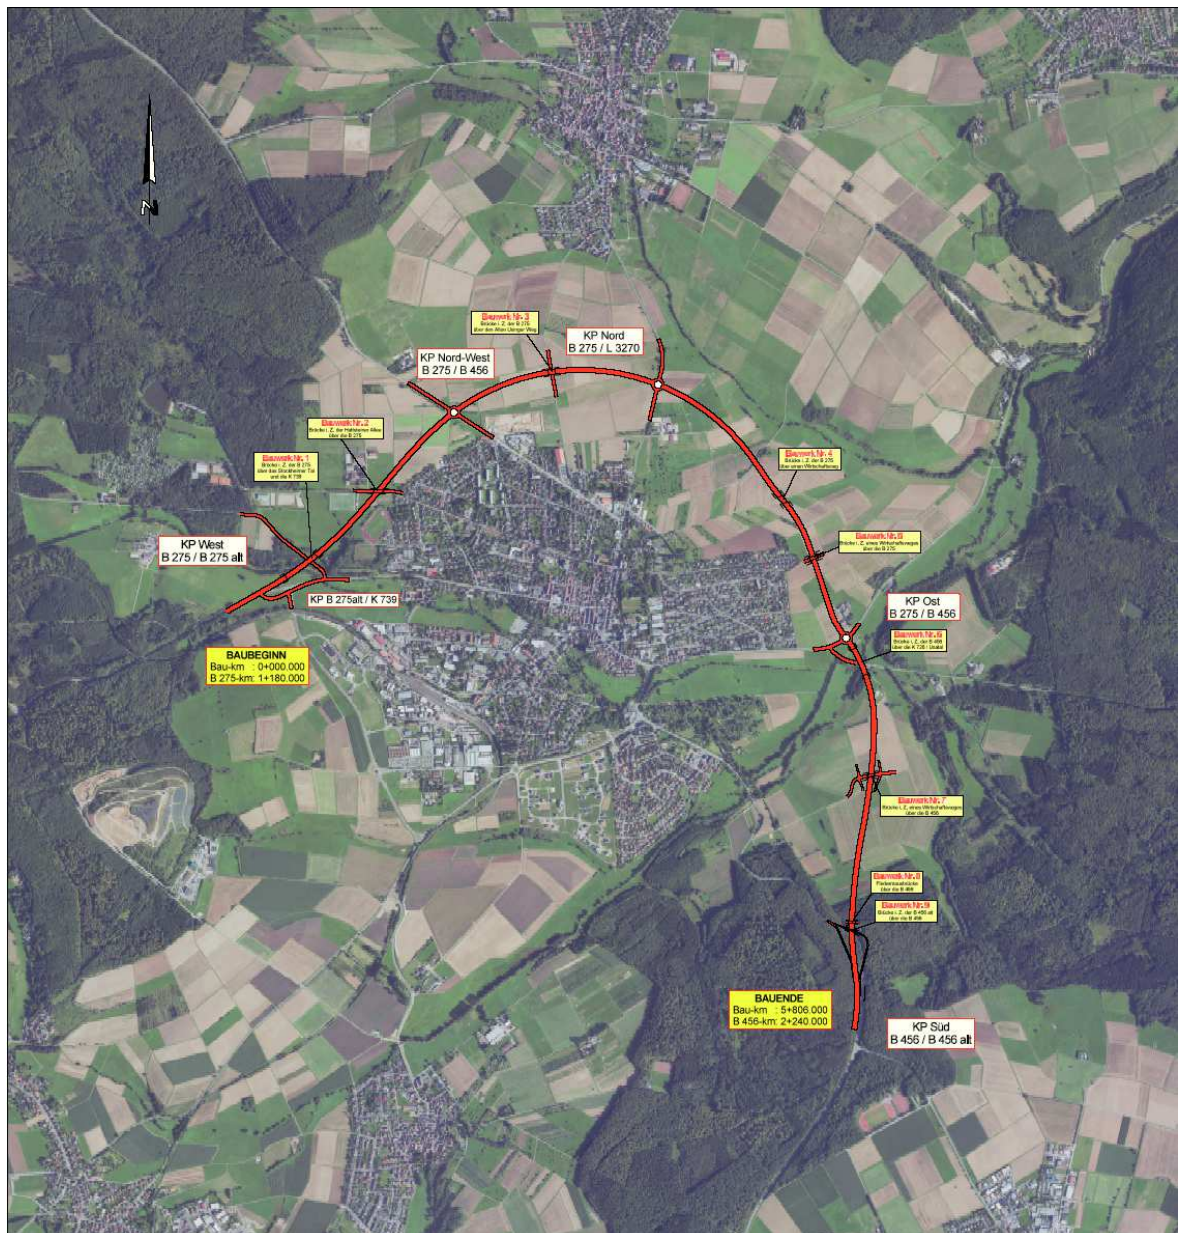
Planfall 5 (Nord-Ostumgehung Usingen - Planfeststellungsvariante)¹
